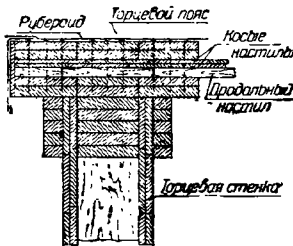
Непосредственное примыкание оболочки к торцевой стенке
